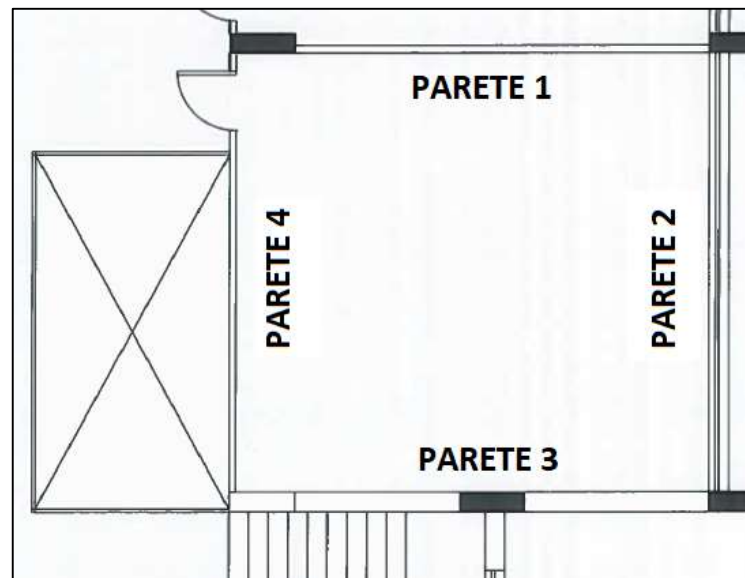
Planimetria dell'aula 3°D oggetto di misurazioni
